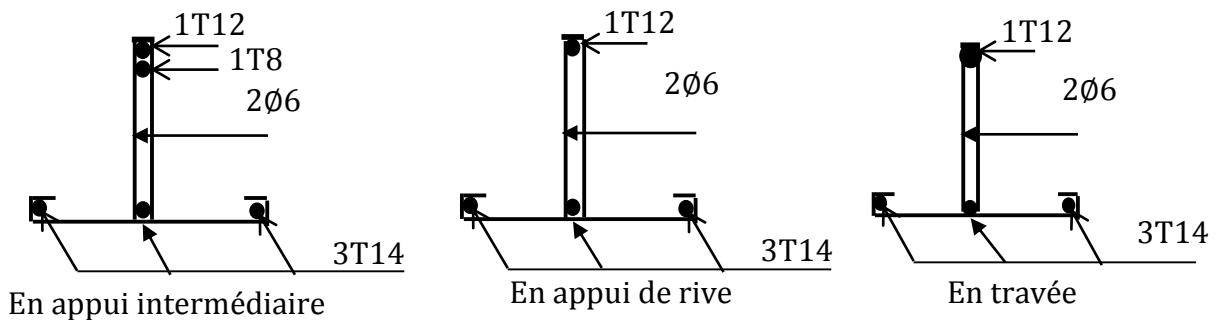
4 : schémas de ferrailage des poutrelles du plancher (16+4)
